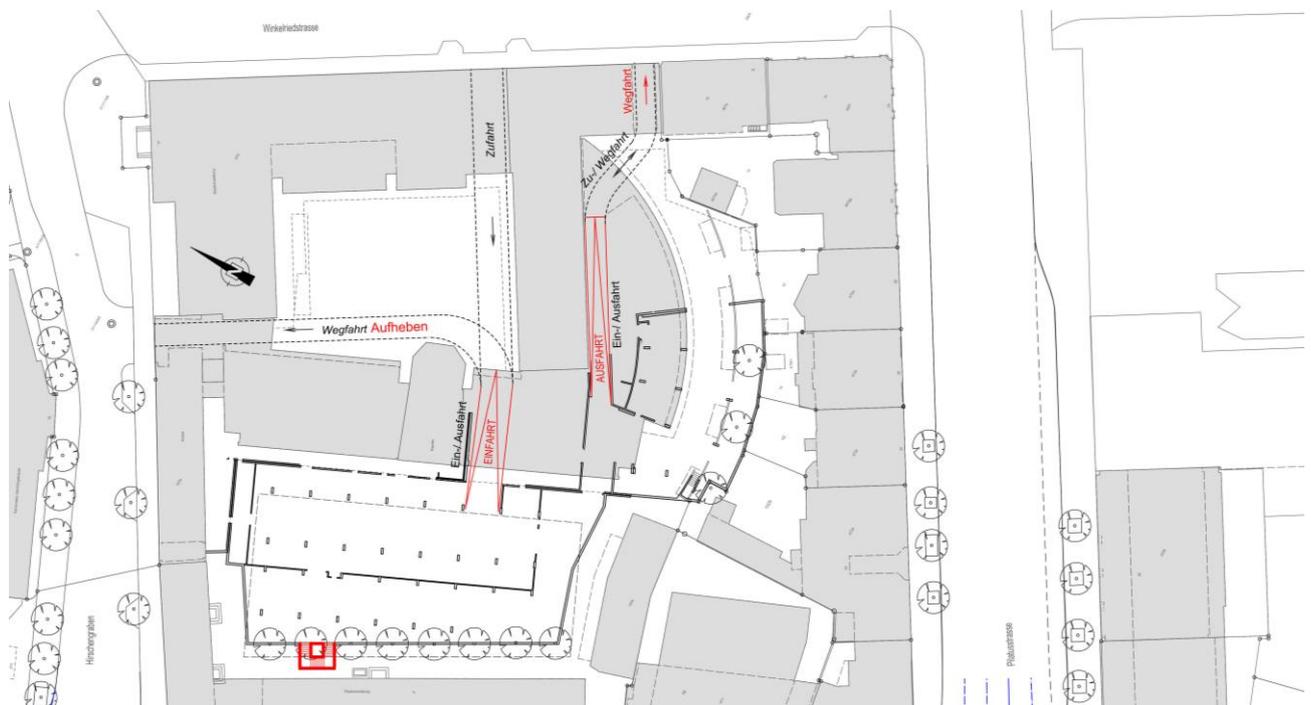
Ausschnitt Situation Variante Stadthaus Oberfläche
